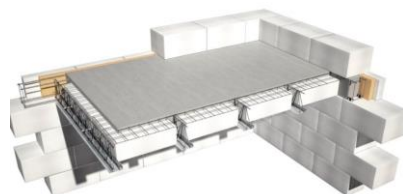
Сборно-монолитные железобетонные перекрытия.
